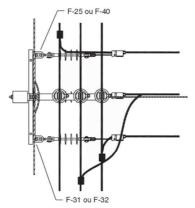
Estrutura CE2-CE3 com suporte horizontal e perfil U – Poste de concreto de seção circular
